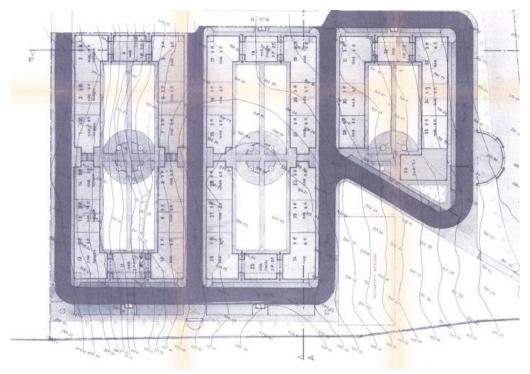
Loteamento Urbano Vivisa - Vila Viçosa
